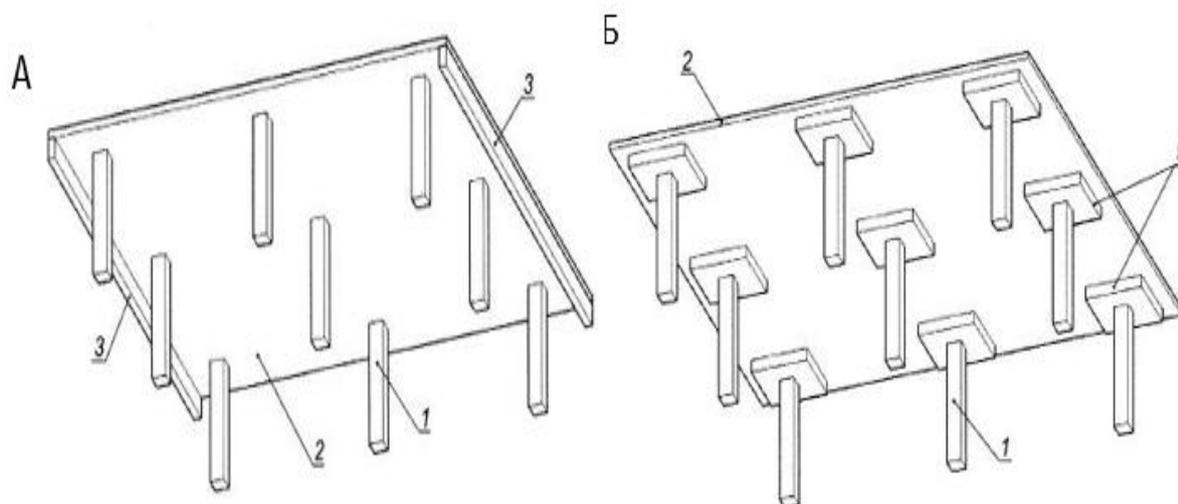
Плиты безбалочных перекрытий в монолитных конструктивных системах:
